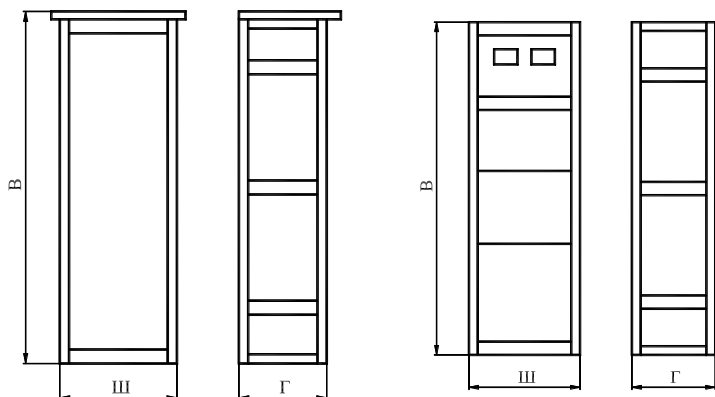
Габаритные размеры корпусов металлических ВРУ-1 (слева) и ВРУ-2 (справа)
